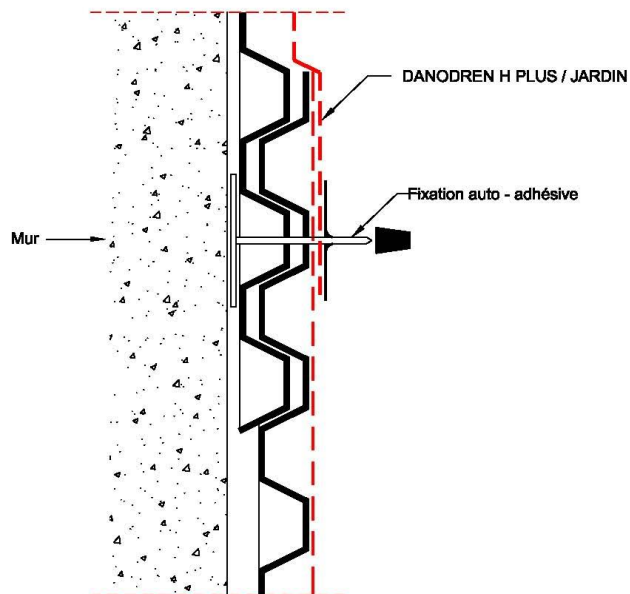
Fixation autoadhésive sur zone de recouvrement DANODREN H PLUS et DANODREN Jardin - pose sans revêtement d'étanchéité
